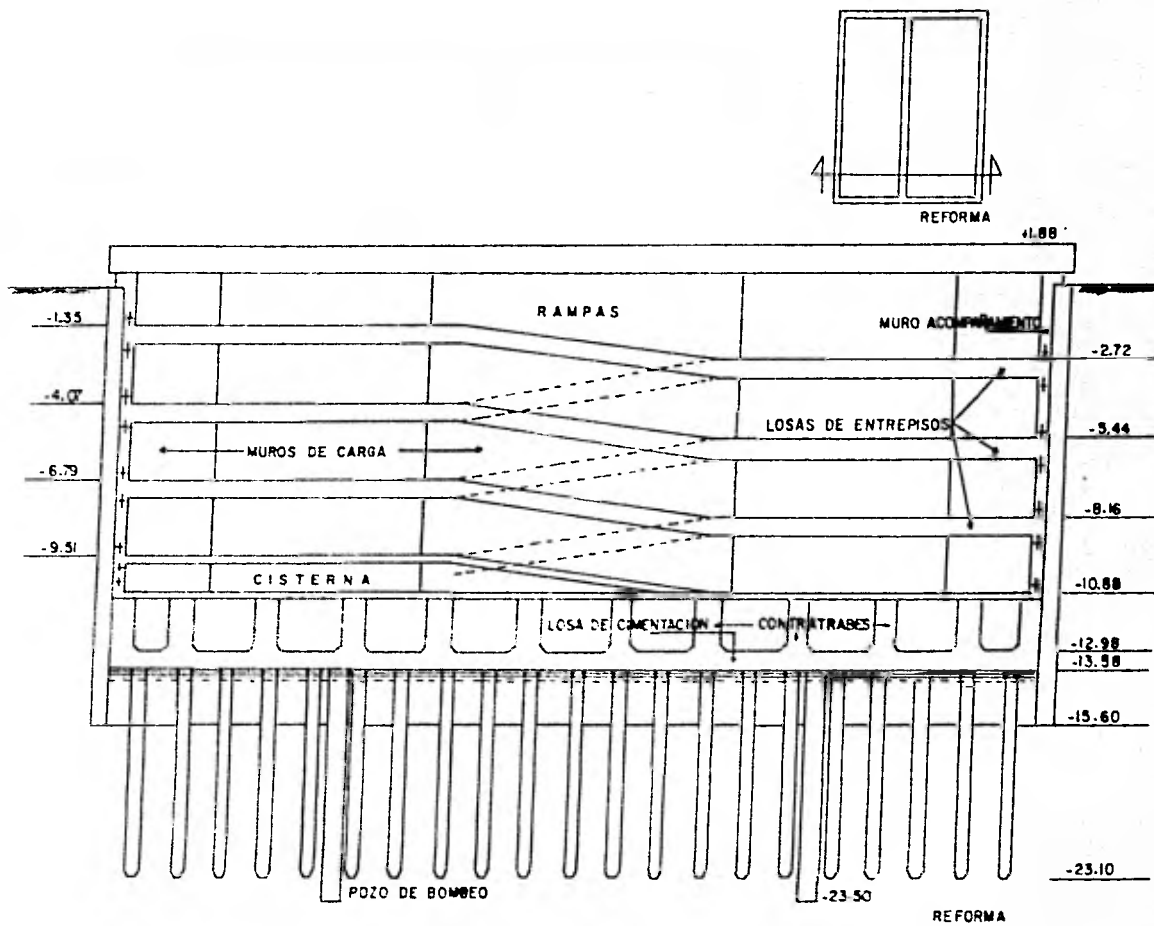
ELEVACION DE CIMENTACION TERMINADA
